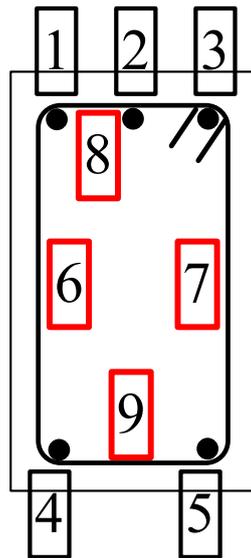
R 梁試體應變計配置圖(黑框表示配置於主筋，紅框表示配置於箍筋)
